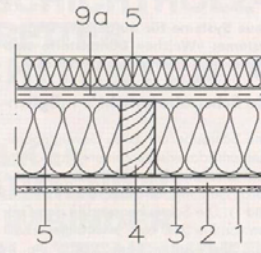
Decke unter nicht ausgebautem Dachgeschoß, nicht belüftet, mit aufliegender Dämmschicht
